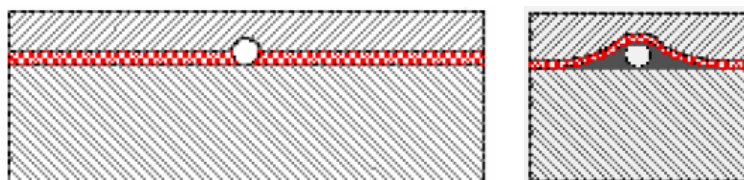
Elevação da manta sobre a parede (a) e corte diagonal na manta (b)
